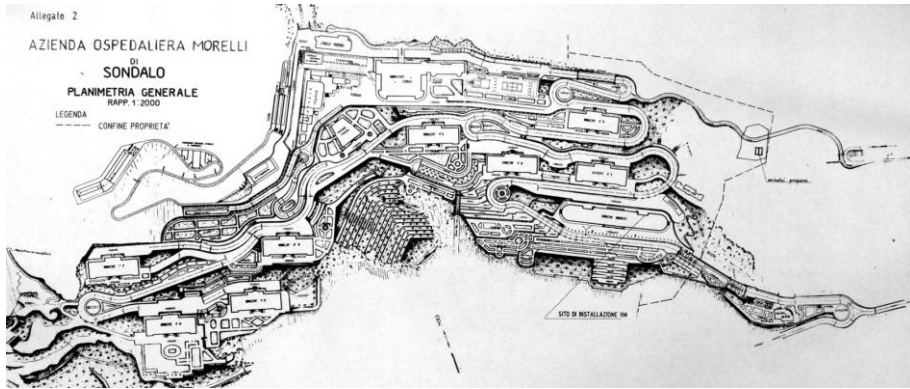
Planimetria generale del Villaggio Sanitoriale di Sondalo (Archivio Ospedale Morelli)
